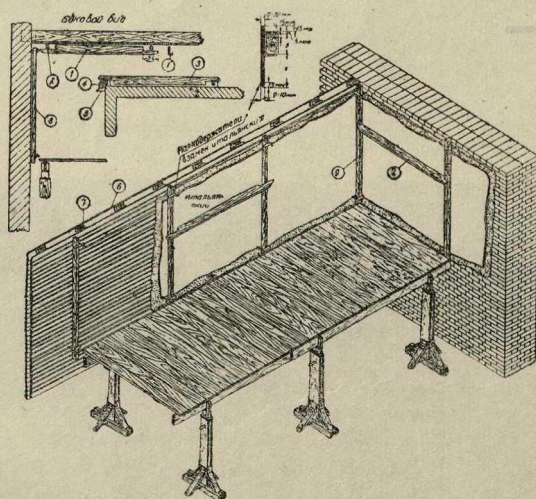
Общий вид подмостей и установка маяков системы Артеменко: 1—малка потолочная; 2—малка угловая; 3—малка для стен; 4—маяк наружного угла; 5—прижимы; 6—тес для перегородки; 7—стойка перегородки; 8—маяки потолка и стен; 9—маяк внутреннего угла.
